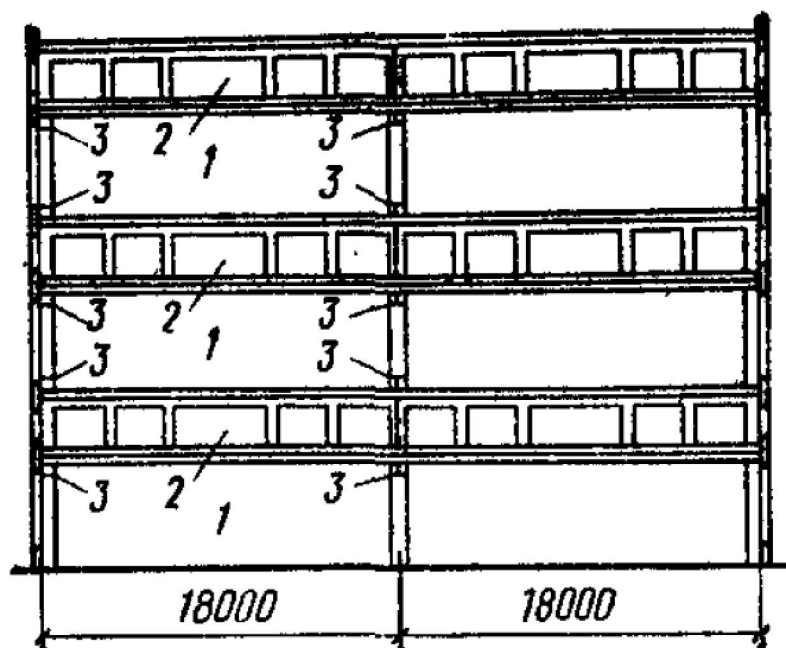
Конструкция многоэтажного промышленного здания с межферменными этажами (1 - основные этажи; 2- межферменные этажи; 3- соединения колонн с безраскосными фермами) [1]
